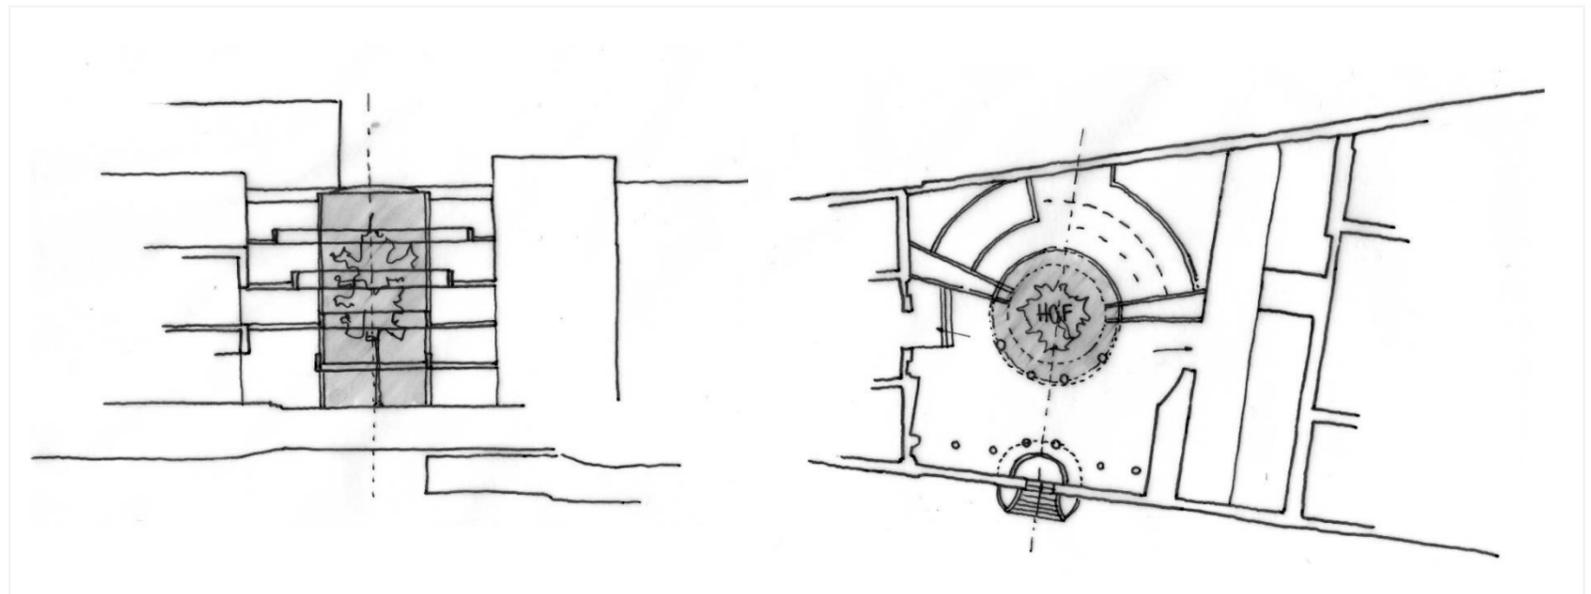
Schnitt & Grundriss Erdgeschoss, 2022
